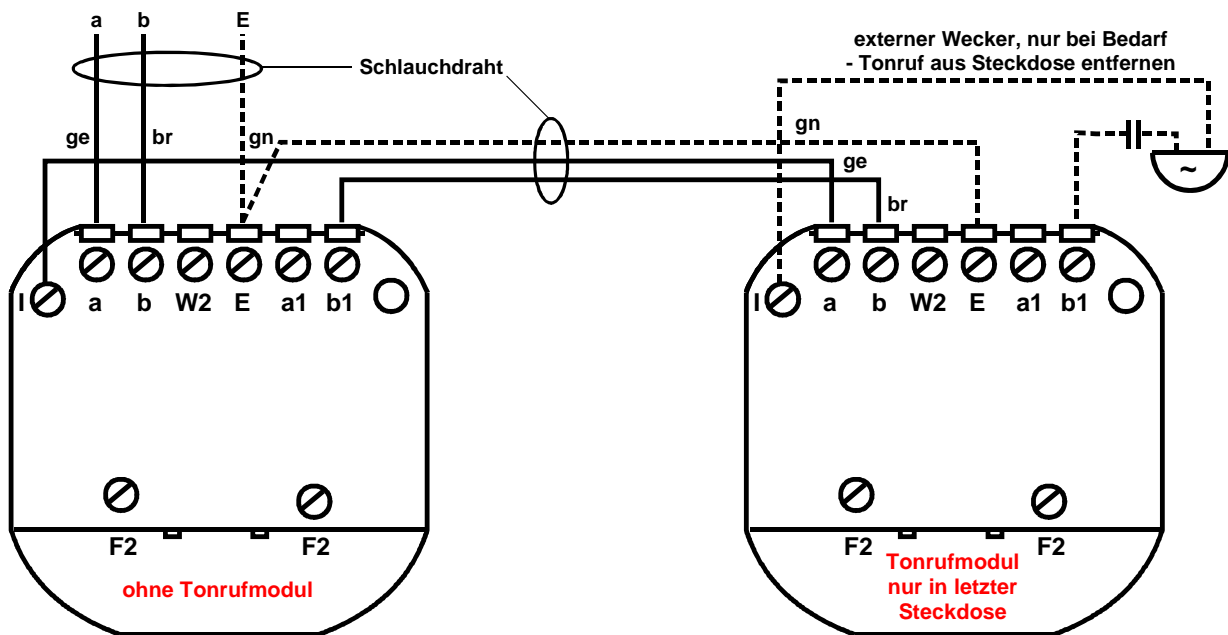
Schaltbild einer Steckdosenanlage mit externem Nebenwecker
